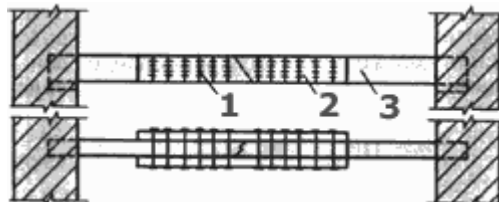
Установка парных накладок по бокам балки: 1 - гвозди; 2 - накладки; 3 - надломленная балка.
